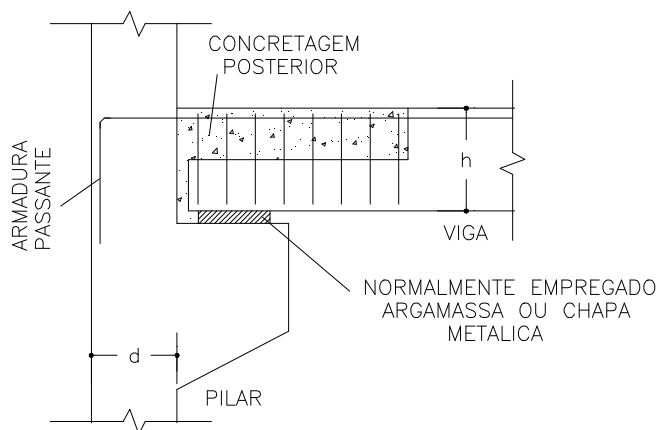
Ligação Rígida Pilar-Viga de Extremidade
